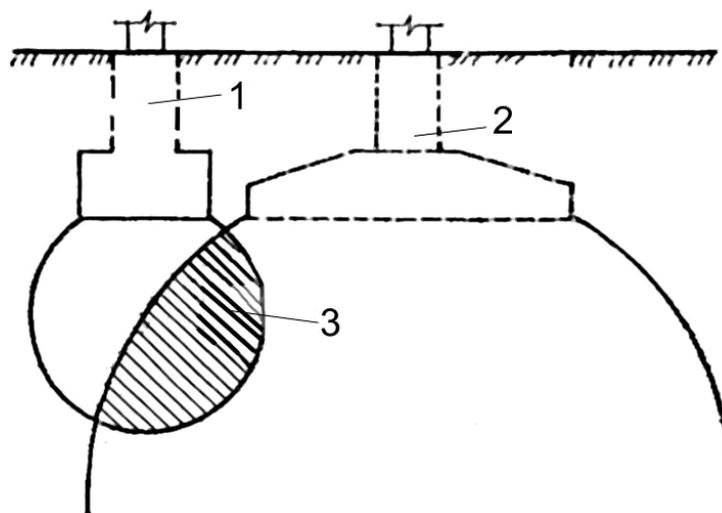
Дополнительное уплотнение грунта в основании: 1 – существующий фундамент; 2 – новый фундамент; 3 – границы зон деформации уплотнения грунта в основании
